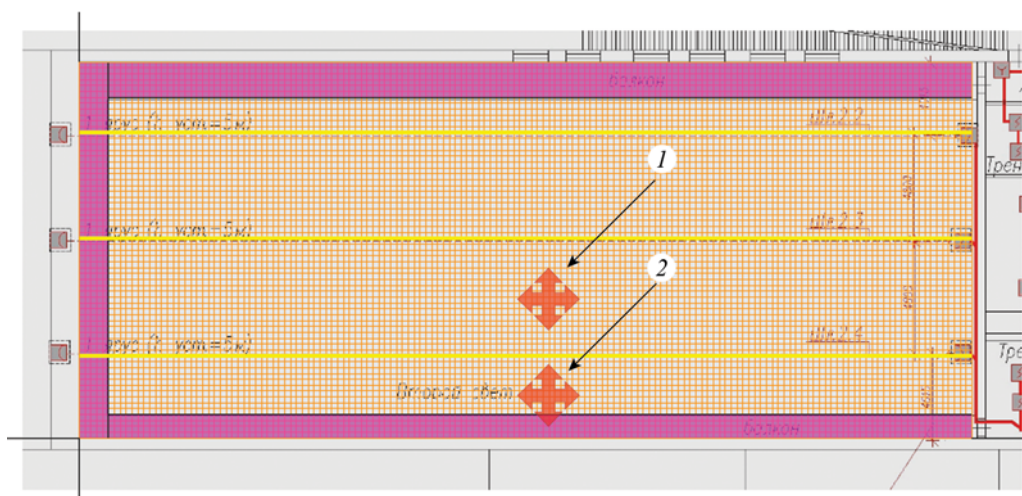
Схема размещения очагов пожара в спортивном зале: 1 — расположение очага пожара для аварийной ситуации № 1; 2 — расположение очага пожара для аварийной ситуации № 2
